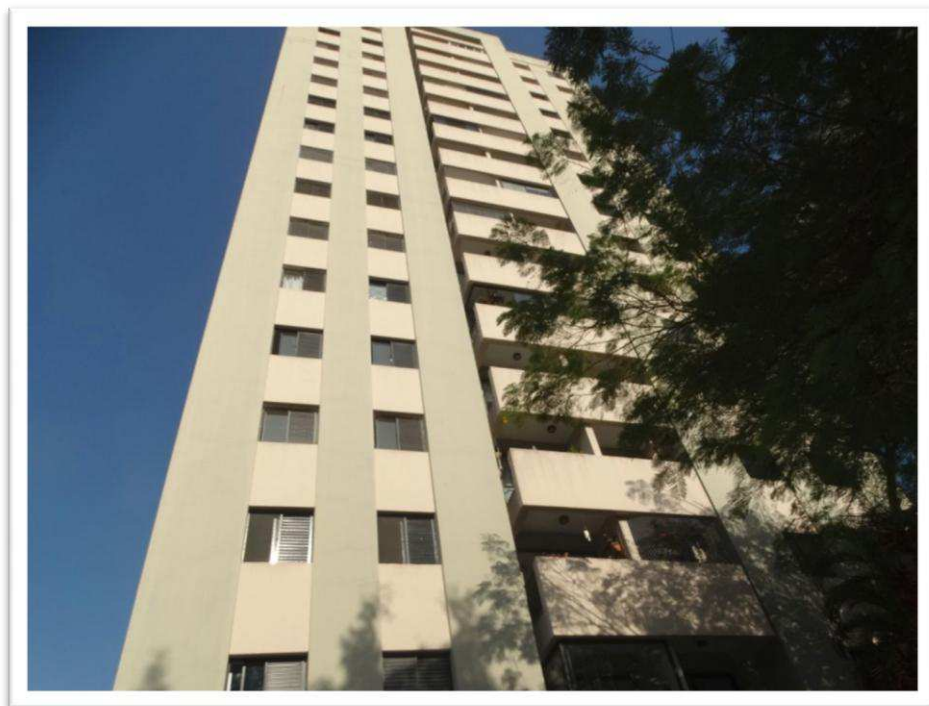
Vista da fachada de fundo do Bloco “B”.
